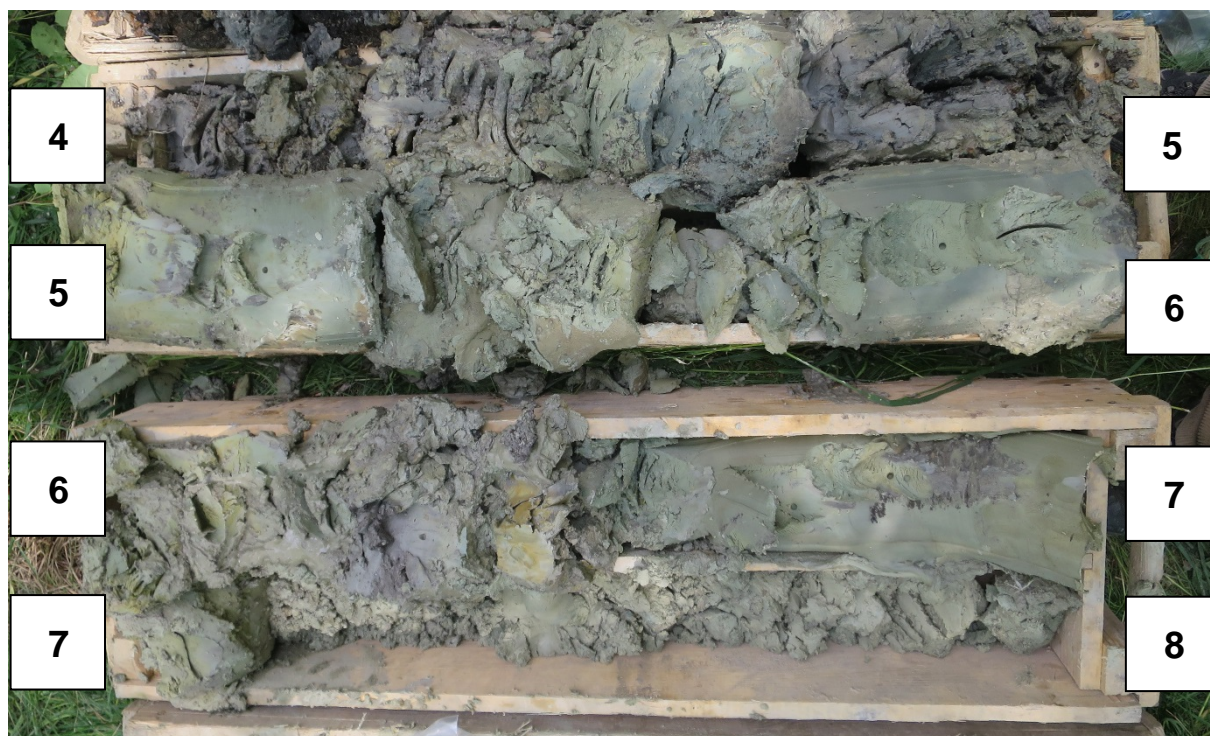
VRT J9 (4,0 – 8,0 m)
